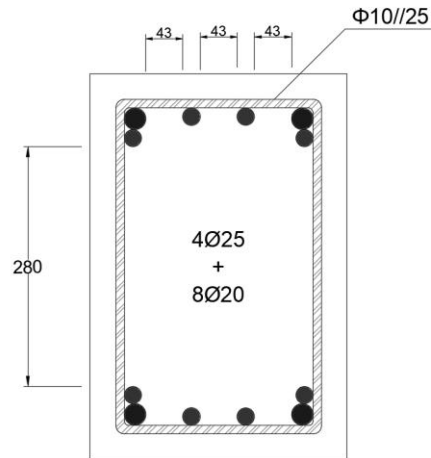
Armadura longitudinal e transversal na viga reforçada.
